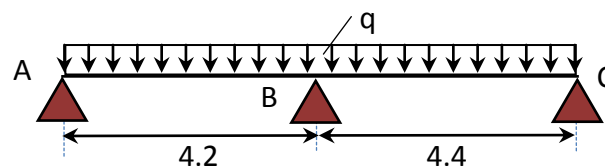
Schéma statique de la poutrelle (type1) du plancher RDC.
